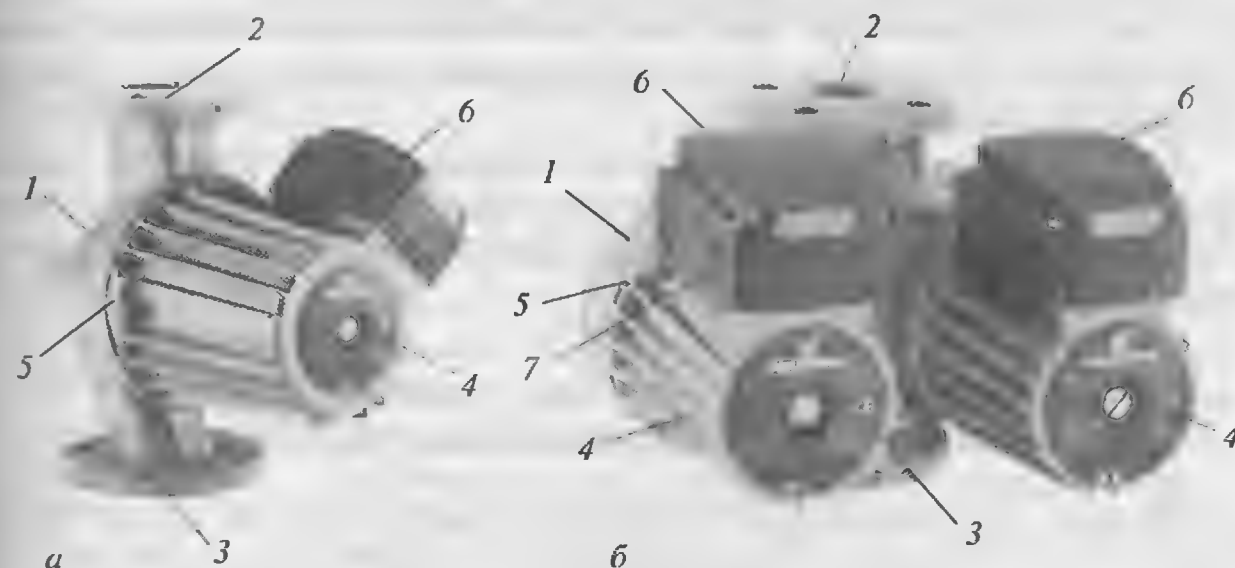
Фотографии конструкции одинарных UPS серии 200 а) конструкция одинарного насоса UPS; б) конструкция двойного насоса UPSD. 1 — корпус из серого чугуна GG20 и бронзы; 2 — нагнетательный патрубок; 3 — всасывающий патрубок; 4 — электродвигатель; 5 — фланец электродвигателя; 6 — клеммная коробка; 7 — ручка изменения частоты вращения в трех возможных положениях
